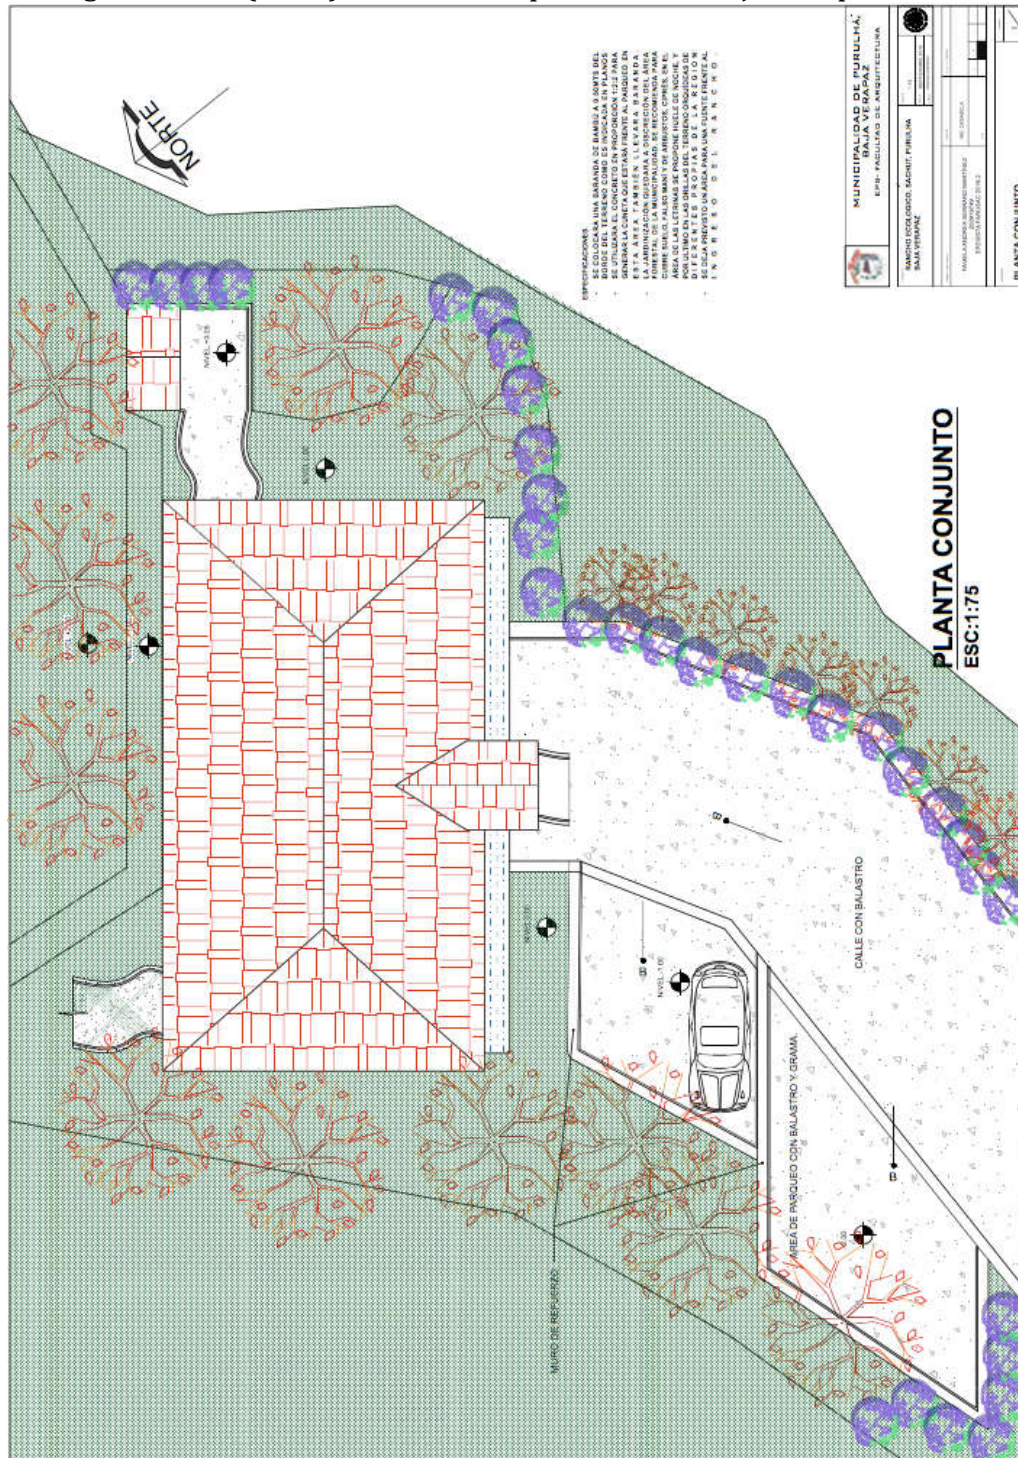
SUM, Planta Conjunto, Elaboración y Diseño propio
